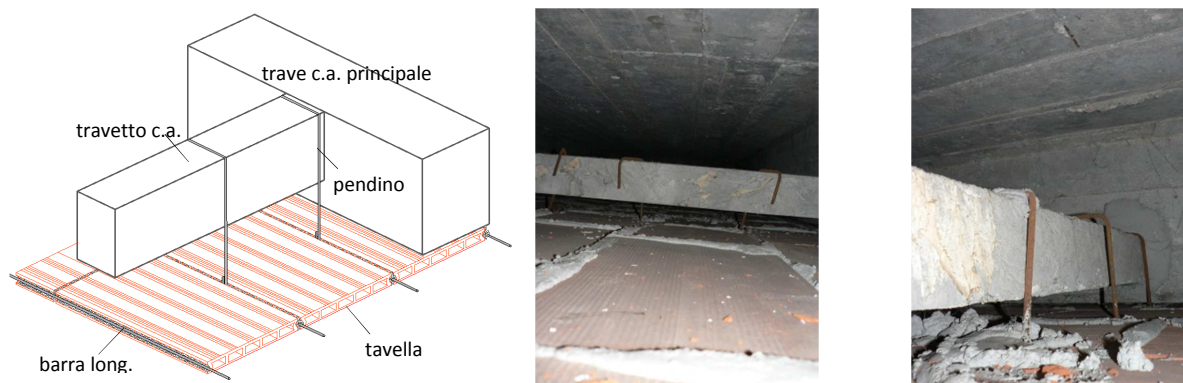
Elementi non strutturali: controsoffitto tipo “Perret” presente a Palazzo Bo
